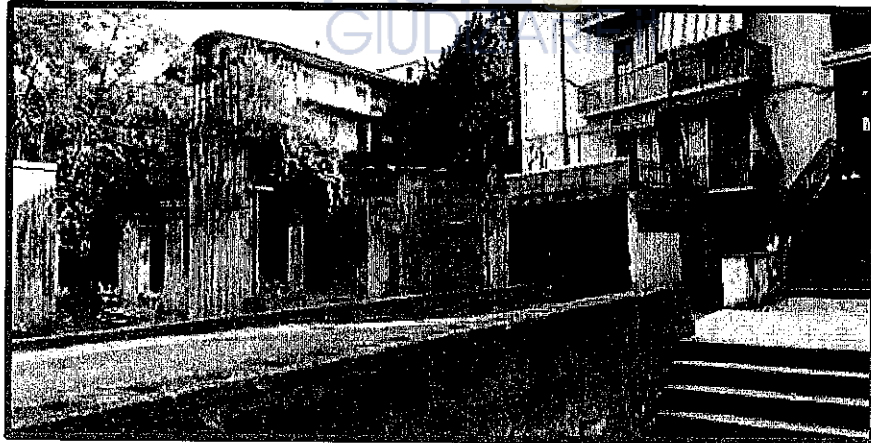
,15,16 - Vista di parte della struttura in c.a. da demolire
